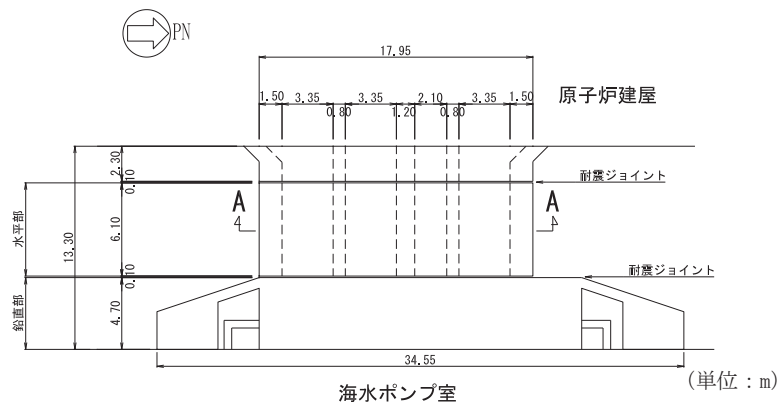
原子炉機器冷却海水配管ダクト（水平部）平面図
